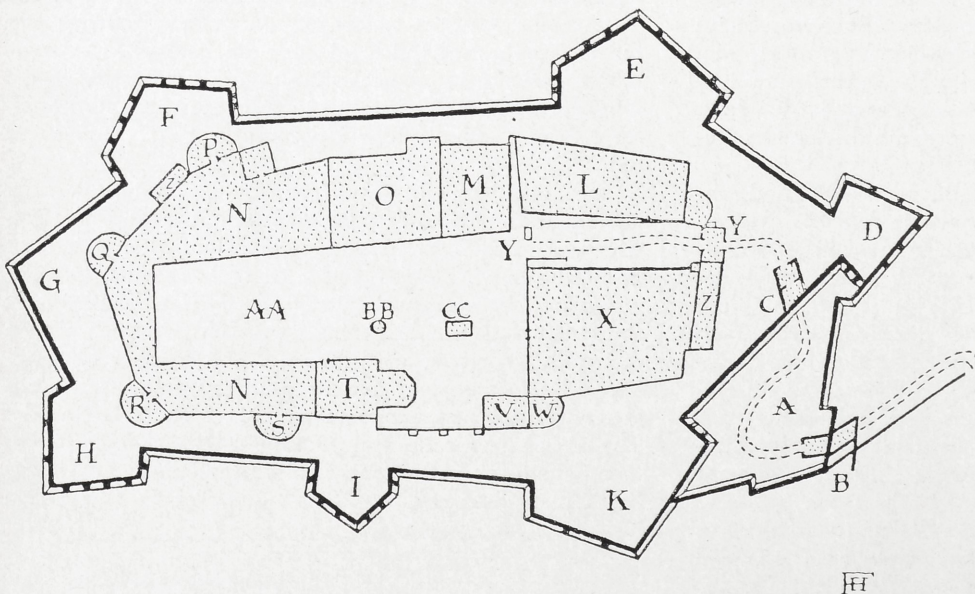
Grundriß der Burg Hohenzollern nach einem Plan von 1692
